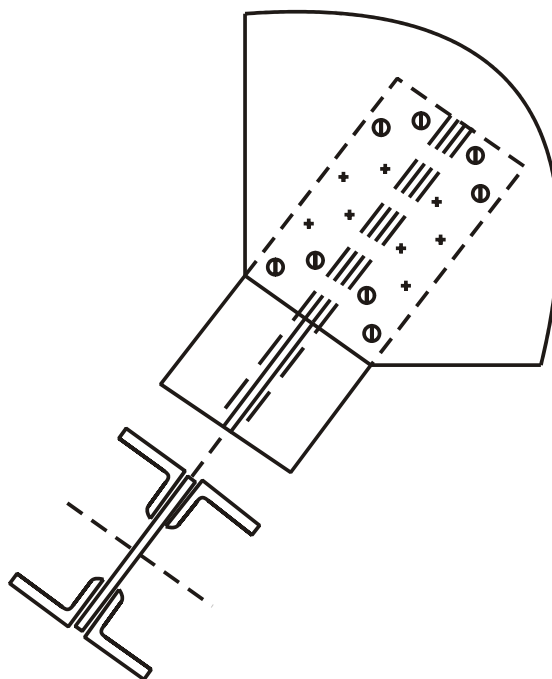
Схема усиления крепления фасонки к раскосу с заменой заклепок высокопрочными болтами (+ - крестиками обозначены заклепки, Θ - кружочками с черточкой высокопрочные болты)
